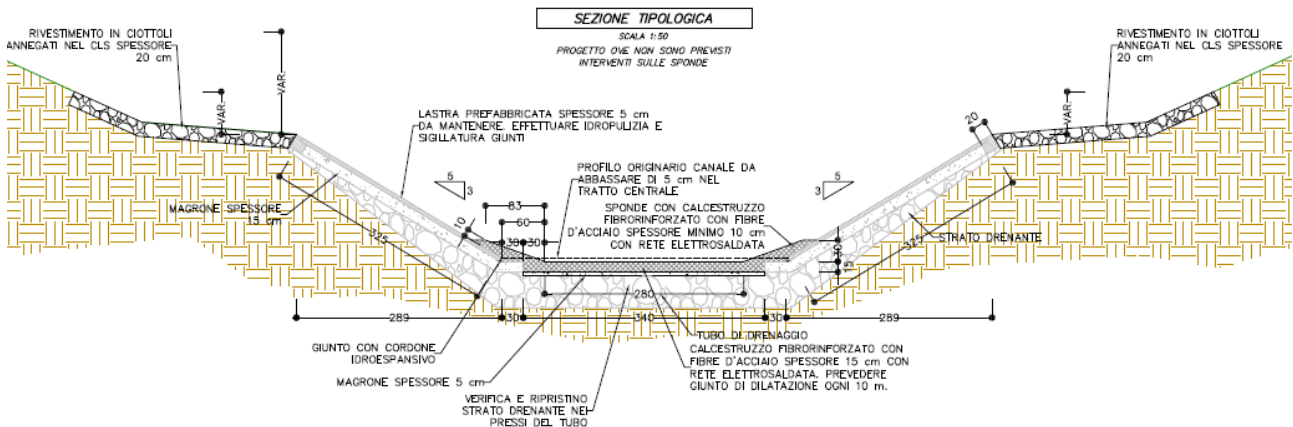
SEZIONE TIPOLOGICA DEL PROGETTO OVE NON SONO PREVISTI INTERVENTI SULLE SPONDE
